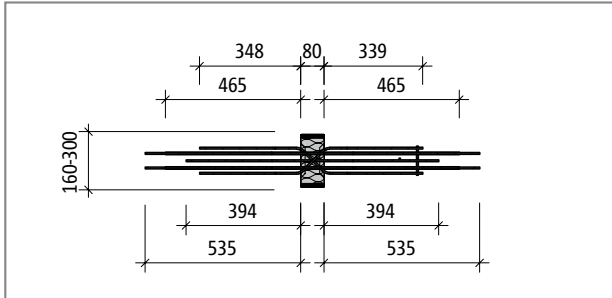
Schöck Isokorb® T Type W-M1 : Plan de base du produit
